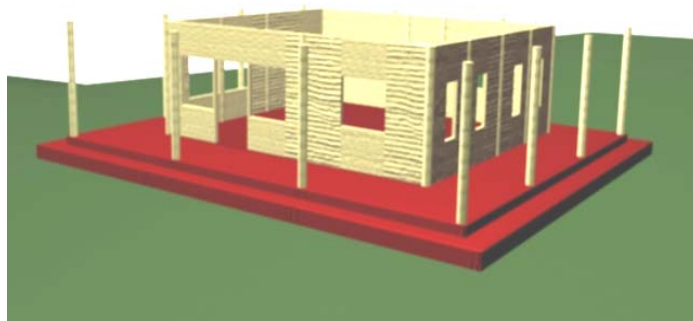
Sistema construtivo, 3º passo : instalação dos painéis de bambu.
